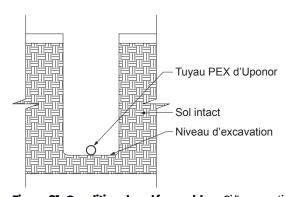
Condition du sol favorable — Si l'excavation de la tranchée se fait sans problème, installer la tuyauterie directement sur le fond préparé. Le fond doit être plat, sans trous, bosses ou cailloux.
